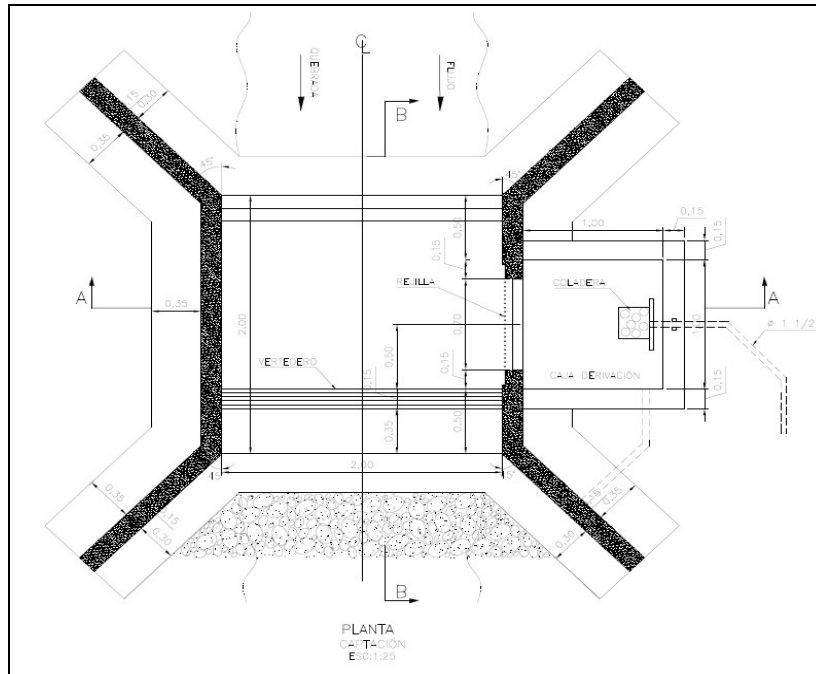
Vista en planta de la estructura de captación para las quebradas – bocatoma lateral
